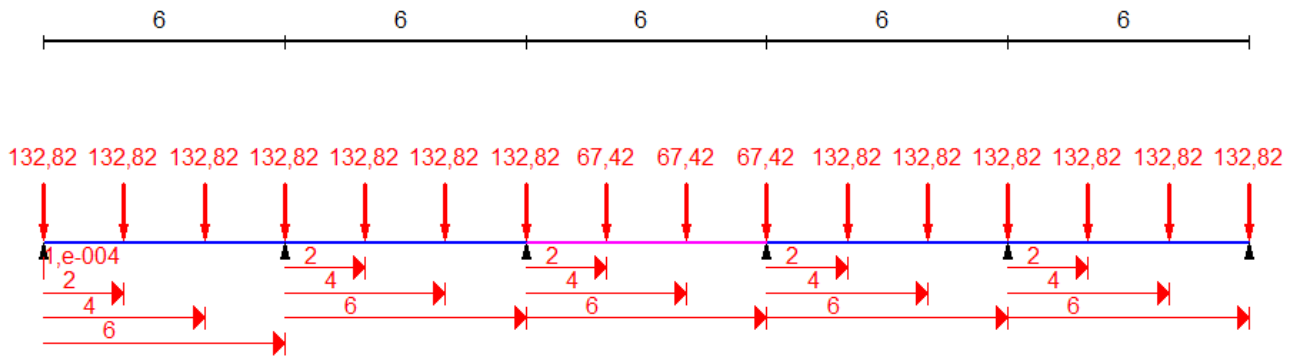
Расчётная схема главной балки, когда временная нагрузка приложена на два крайних пролёта с каждой стороны
